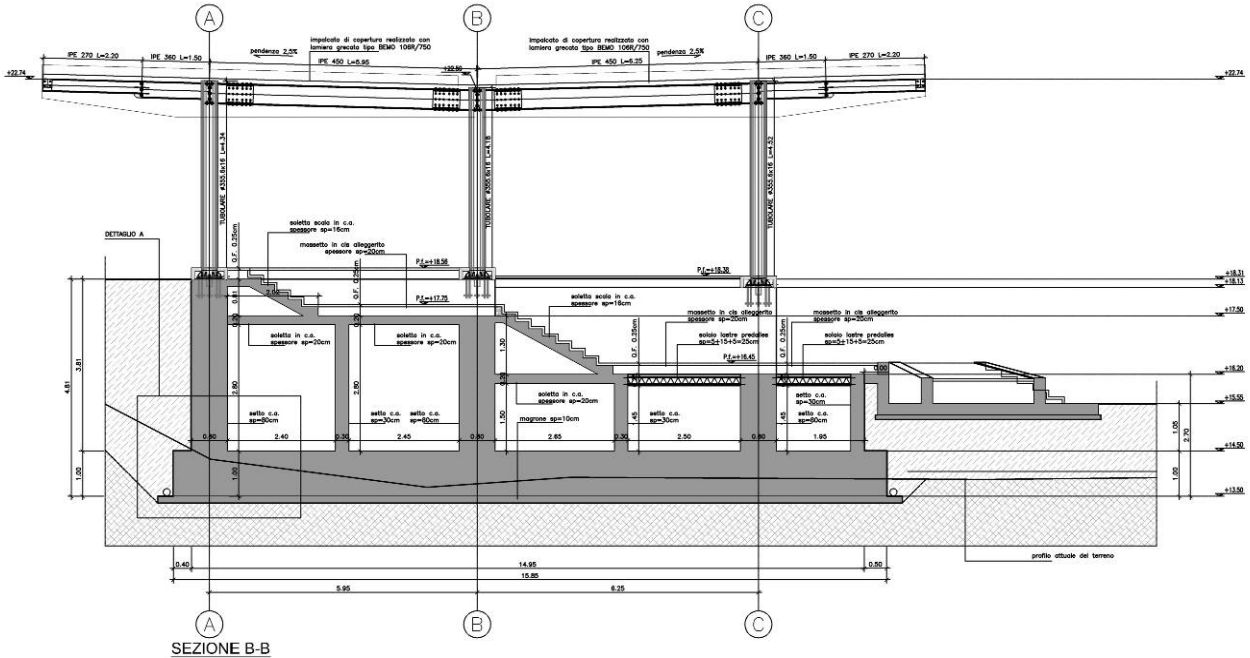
Sezione trasversale tipo dell'edificio fermata
